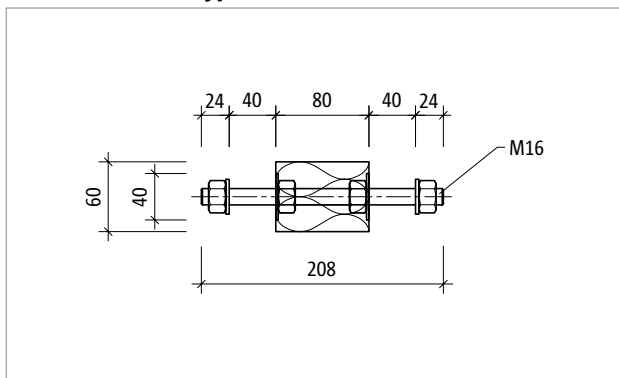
Schöck Isokorb® T type S-N-D16 : coupe du produit
